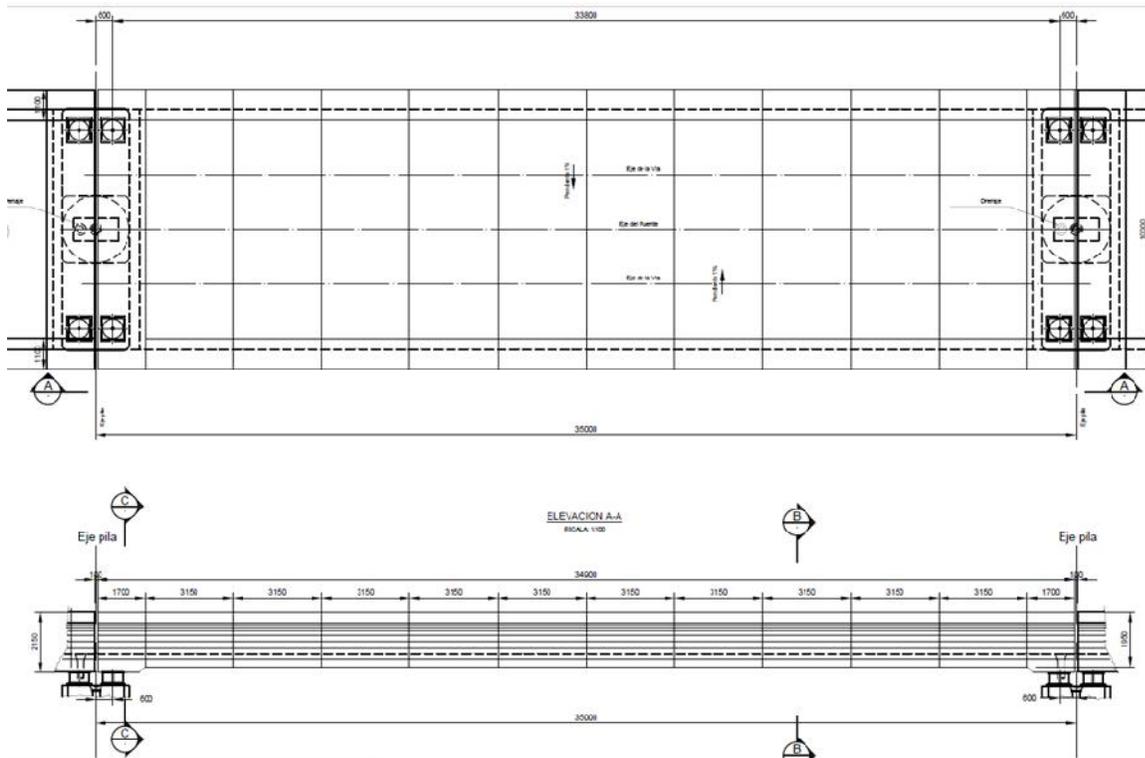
Tramo tipo viaducto elevado vista en planta y elevación
